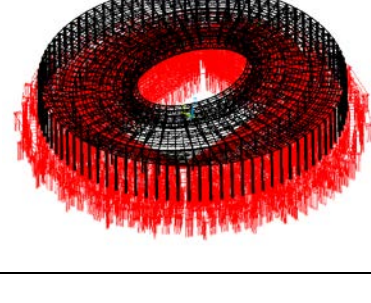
Фрагменты конечноэлементной модели полной системы «основание – железобетонные конструкции фундаментов и трибун – металлические конструкции покрытия» стадиона в Нижнем Новгороде
